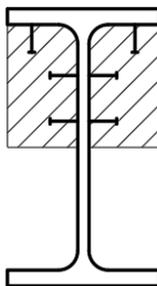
Схема бетонирования между полками двутавра в сжатой зоне
